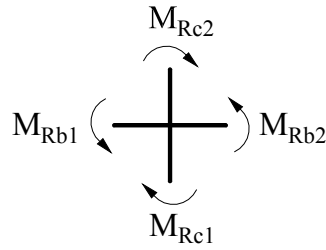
Echilibrul momentelor încovoietoare la un nod interior pentru o structură în cadre.
